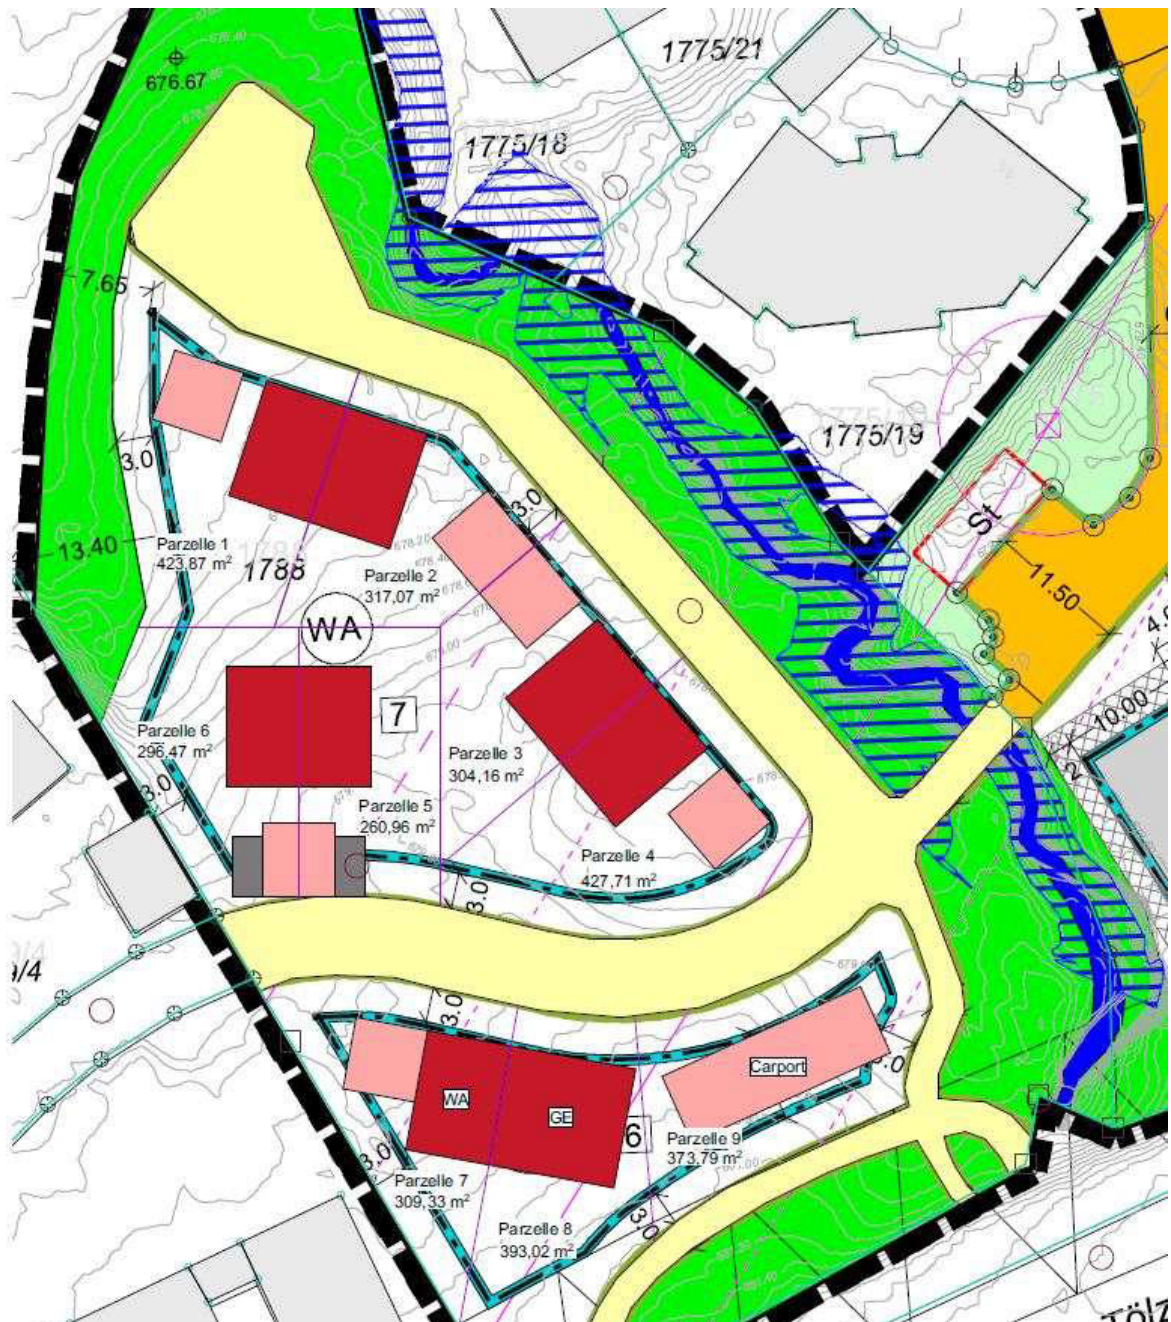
Lageplan Bebauungsplan „Am Krebsenbach – Angerlstraße“ (© Gemeinde Bad Heilbrunn)
